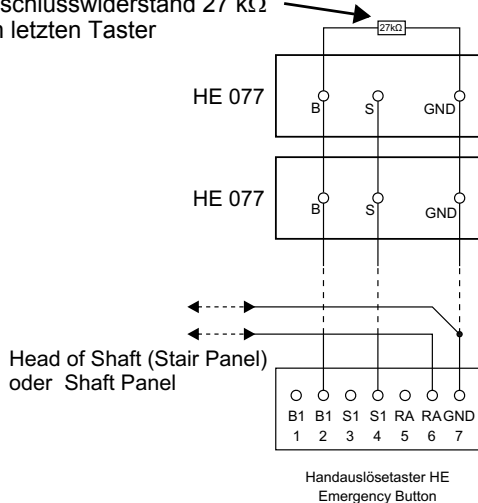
Anschlussplan Handansteuereinrichtung HE 077 (Stair Panel)
